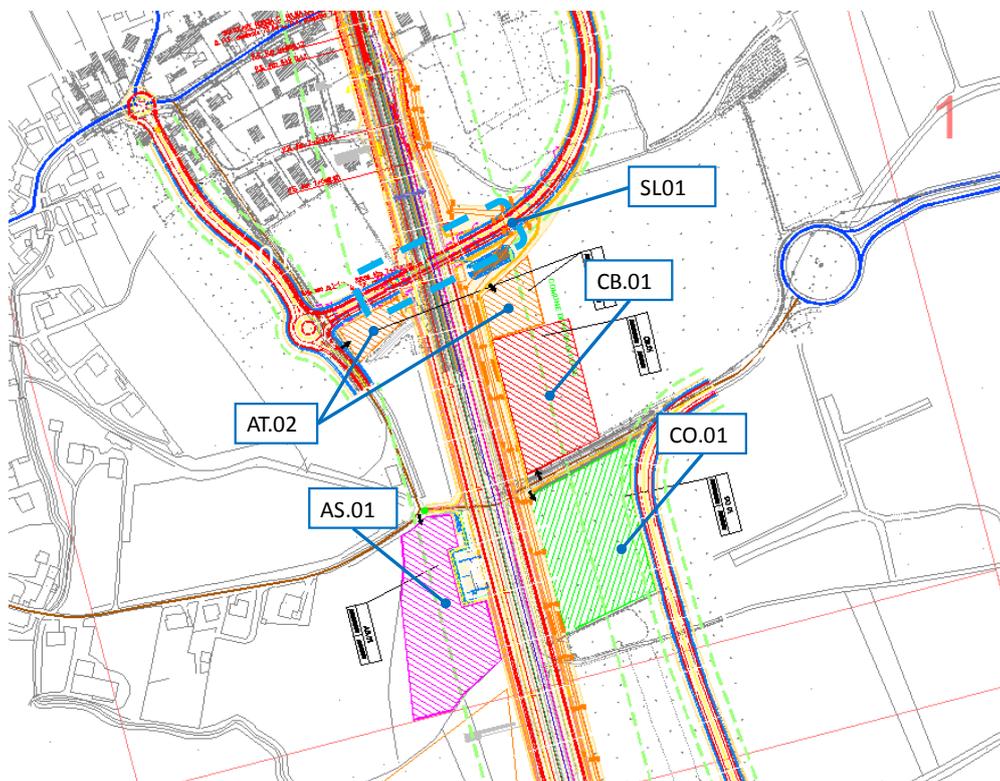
Localizzazione delle aree di cantiere e attività di lavorazione
